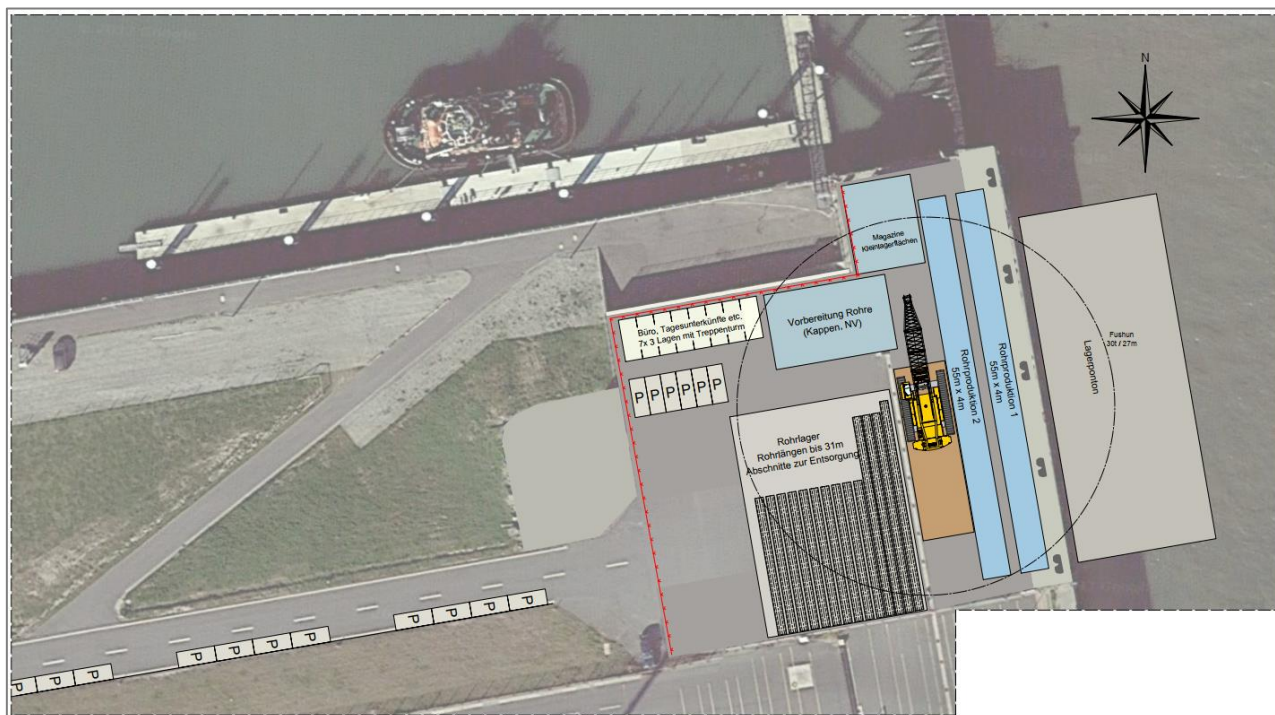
Entwurf der Baustelleneinrichtungsfäche auf der Project Pier des JadeWeserPorts
